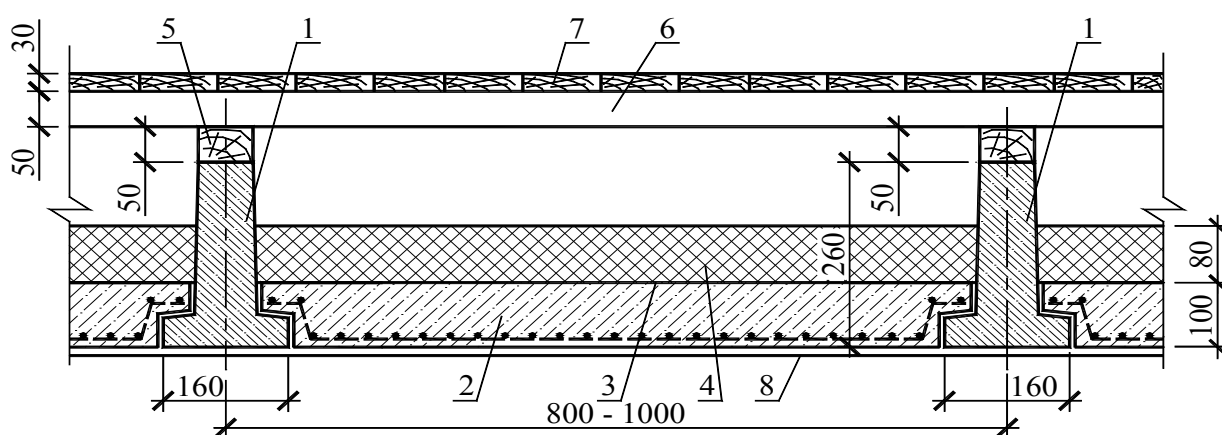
Схема межэтажного перекрытия с железобетонными балками и газосиликатными вкладышами: 1 – железобетонная балка таврового сечения; 2 – газосиликатный вкладыш; 3 – пароизоляция; 4 – звукоизоляционный материал; 5 – деревянная подкладка; 6 – деревянная лага; 7 – половая доска; 8 – обшивка потолка
